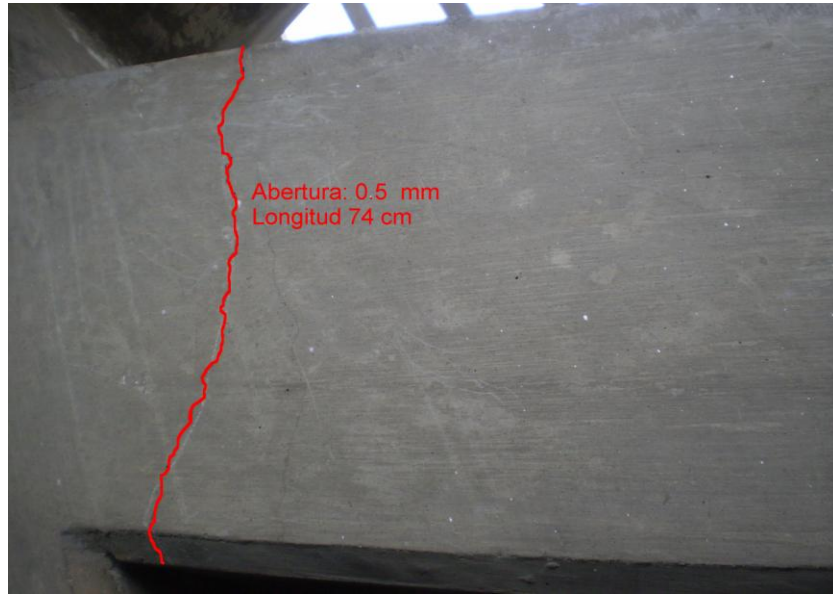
Fisura en viga inclinada de la escalera.
